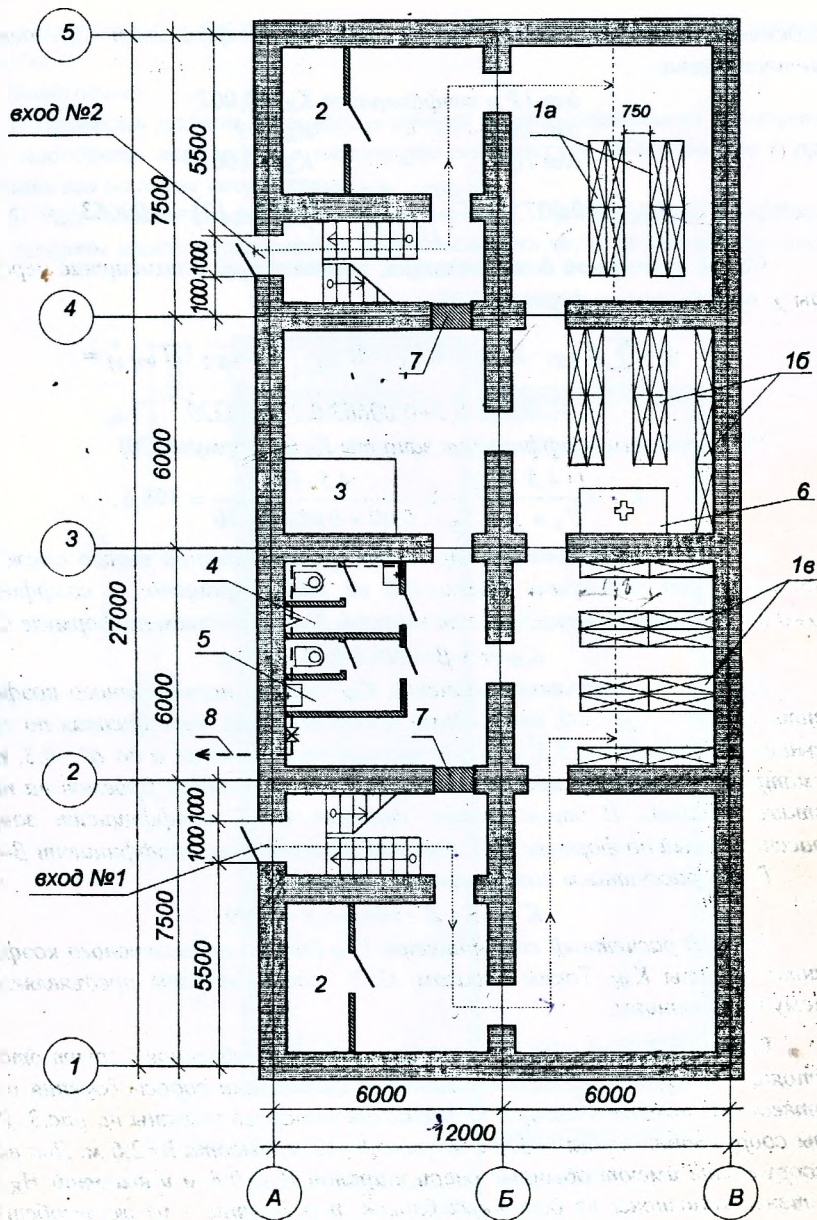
План ПРУ: 1- трехъярусные нары (1а- продольные ряды с двусторонним выходом, 1б- продольные ряды с односторонним выходом, 1в- поперечные ряды); 2- помещения для загрязненной одежды; 3- место размещения вентиляционных установок; 4- мужской санузел; 5- женский санузел; 6- санитарный пост; 7- заделанные дверные проемы; 8- выпуск сточных вод.
